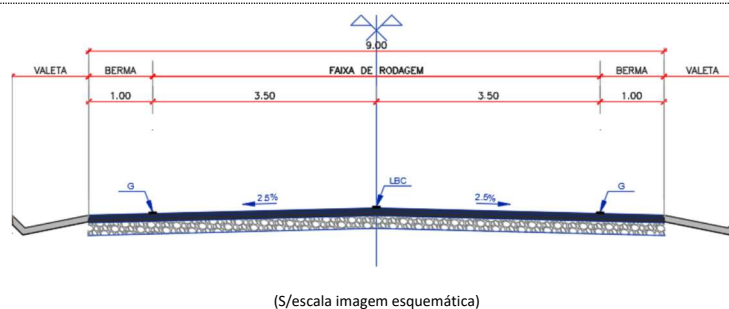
Perfil Transversal Tipo – Restante traçado
